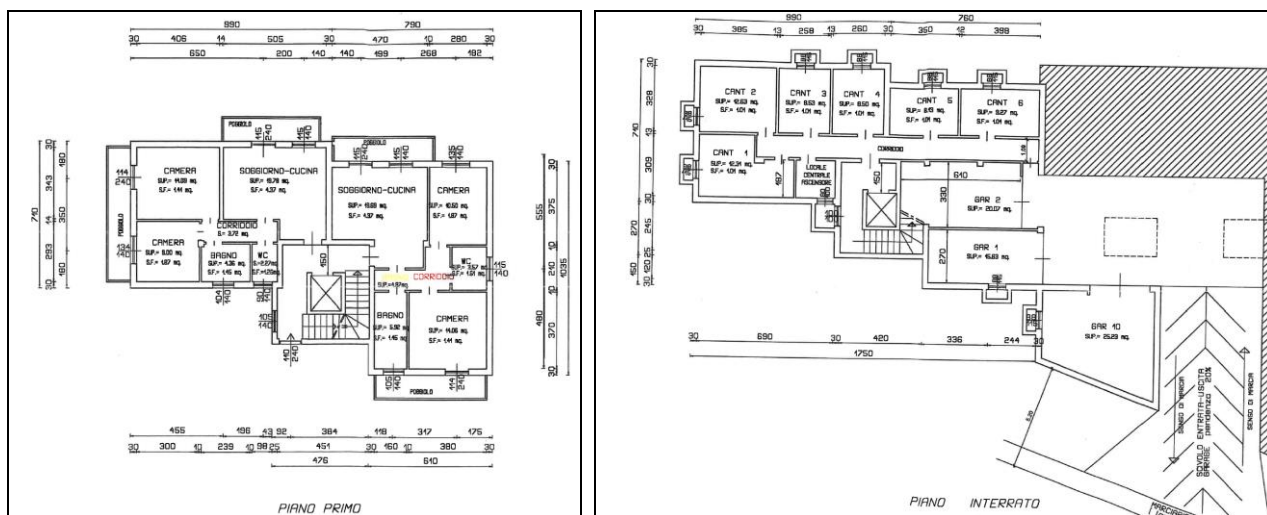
Planimetrie Comunic. Iniz. Attiv. Prot. N. 682/UT Pratica n° D03/0025 del 25/07/2003 ([Allegato N.7](#))
